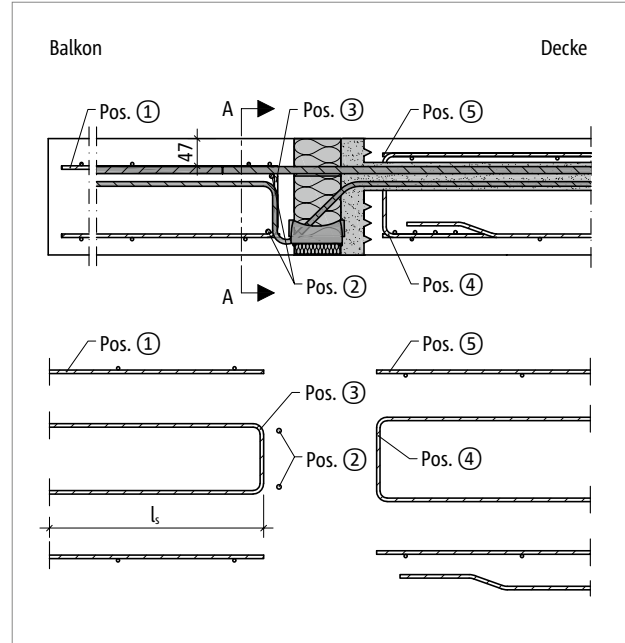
Schöck Isokorb® RT Typ K: Bauseitige Bewehrung bei indirekter Lagerung
